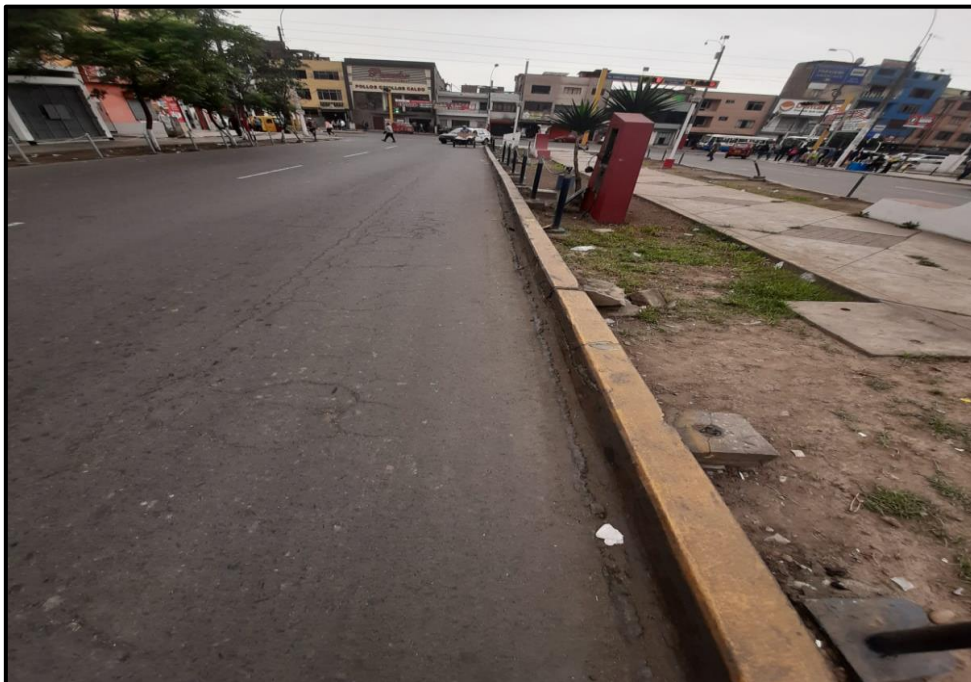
En la imagen se puede apreciar la falla de ahuellamiento y grietas longitudinales
